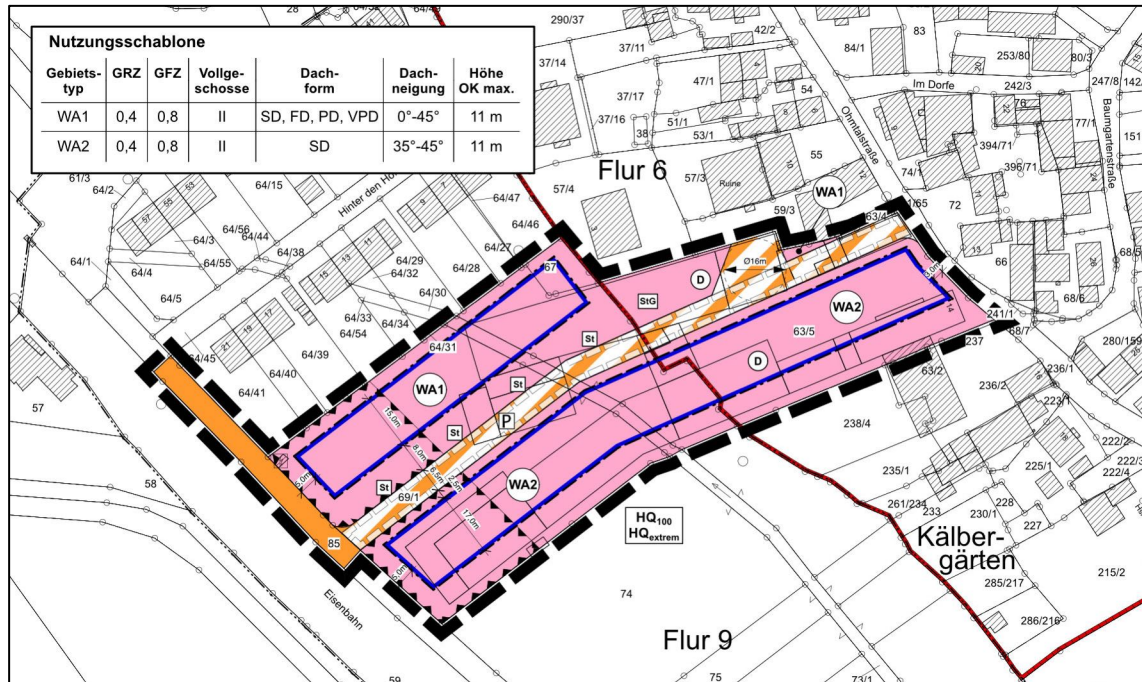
Bebauungsplan „Ohmtalstraße 14“ - Planteil
